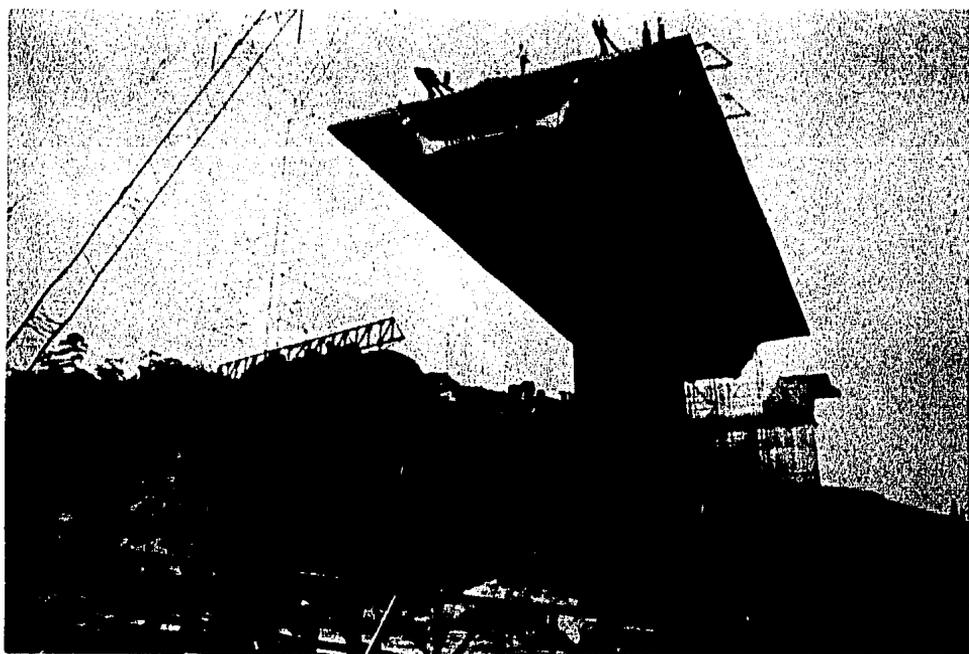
DESMONTAJE DEL CARRO MOVIL DE COLADO.
